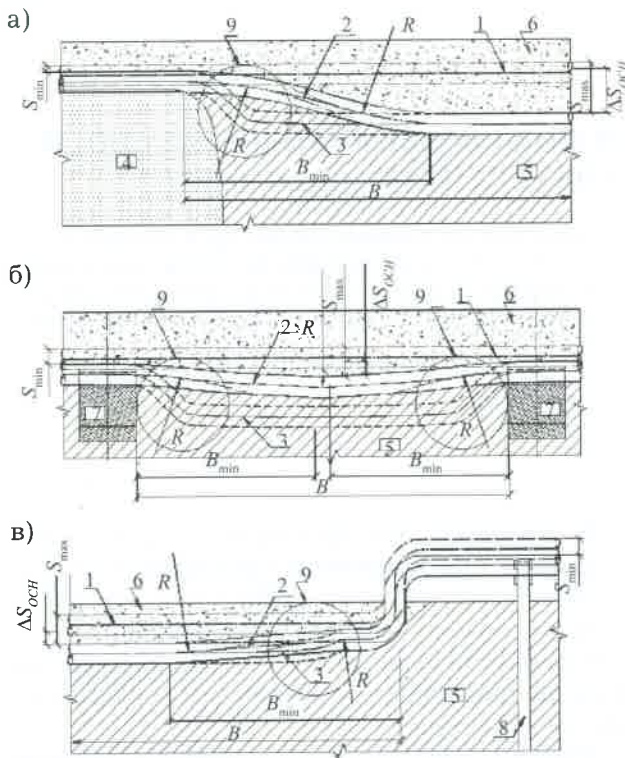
Схемы наиболее опасных участков трубопровода подземной прокладки:
